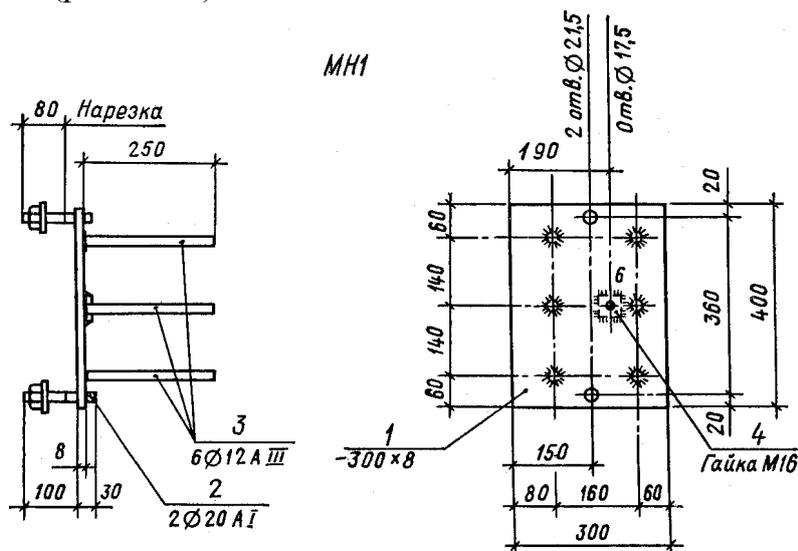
Сборочный чертёж закладной соединительной детали
